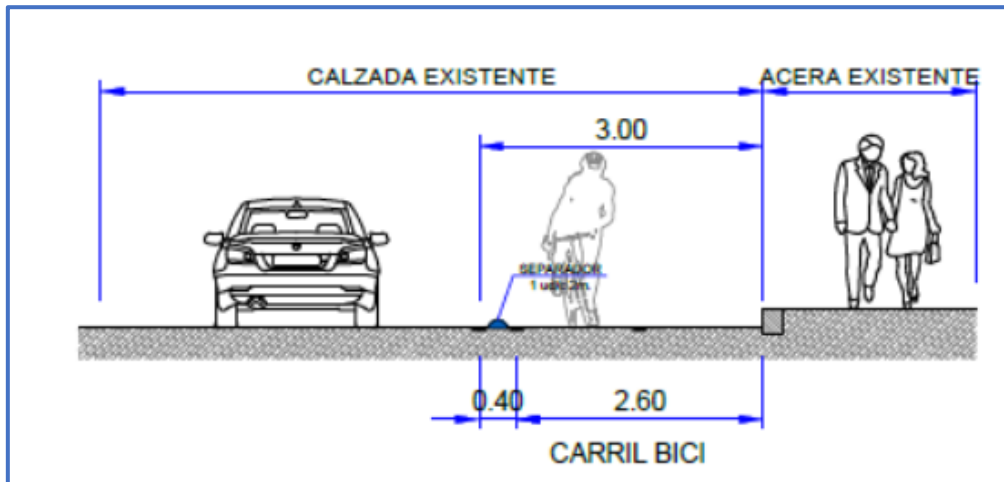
Sección transversal tipo carril bici en la propia calzada de la calle Miravalles
